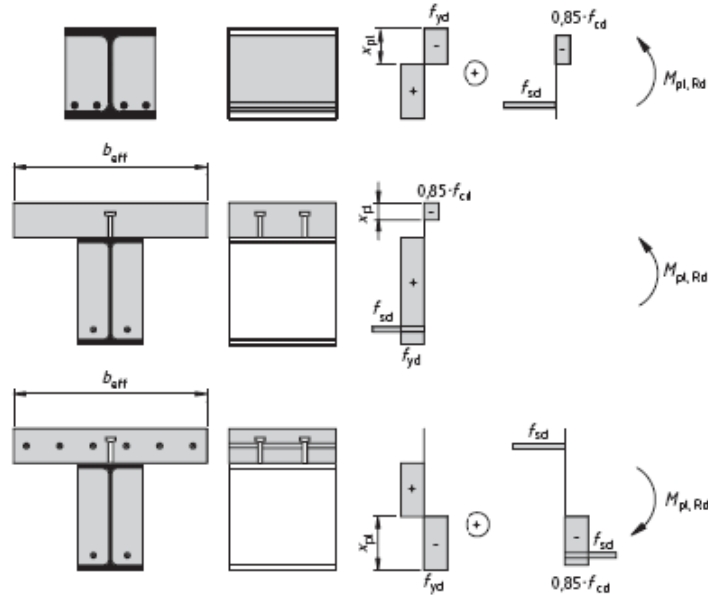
Exemplos da distribuição de tensões, para uma viga mista com conexão total, a meio vão e apoio interno
